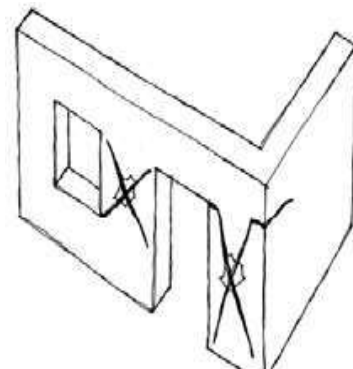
écrasement de la façade due aux poussées des ouvertures
